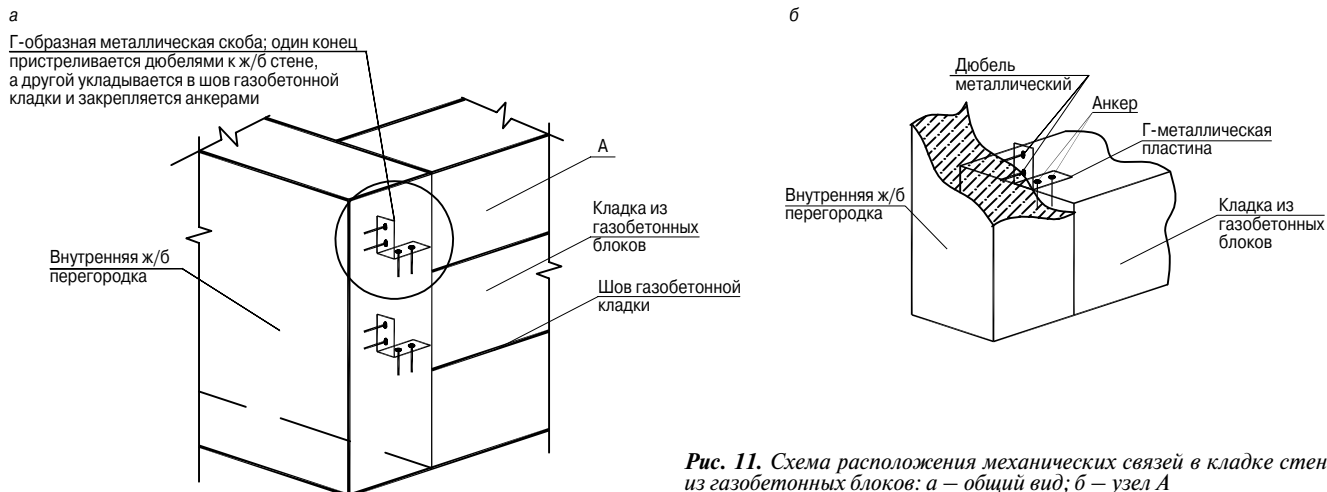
Схема расположения механических связей в кладке стен из газобетонных блоков: а – общий вид; б – узел А
